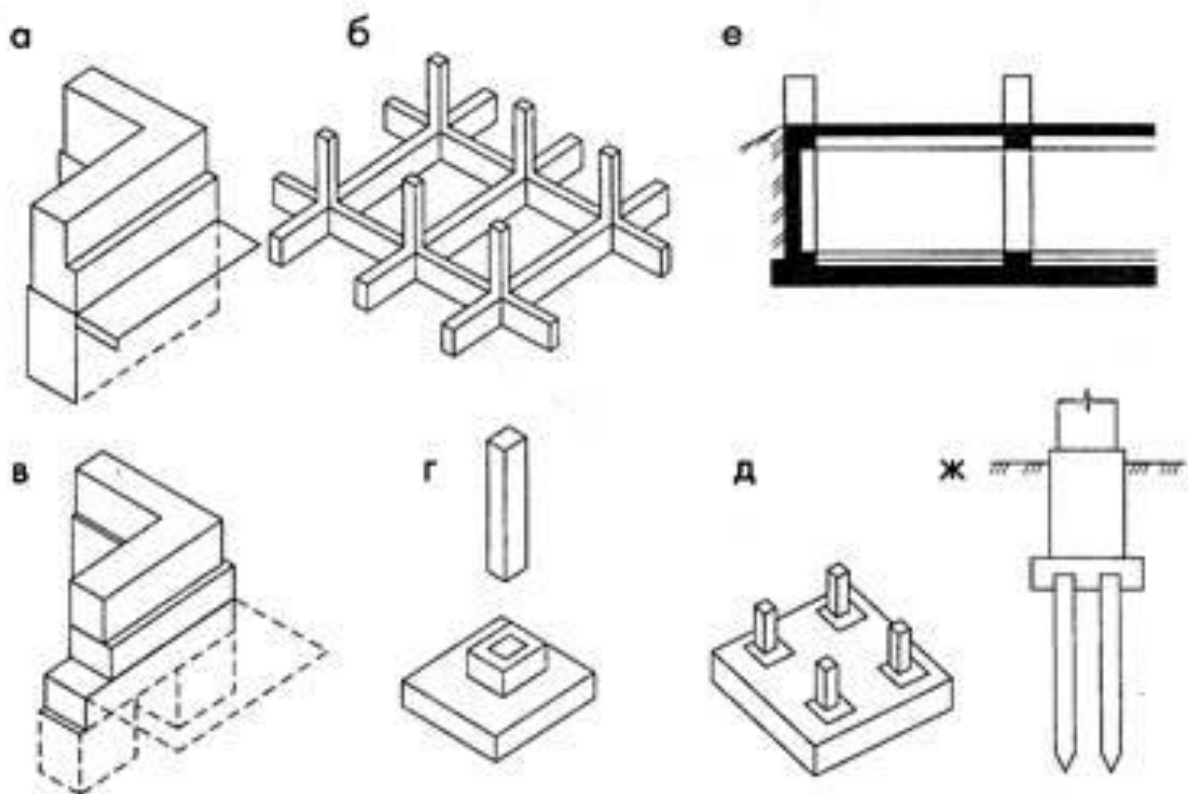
Типи фундаментів: а – стрічковий під стіни; б – стрічковий монолітний під колони; в – стовпчастий під стіни; г – стовпчастий стаканного типу під колону; д – суцільна плита під колони; е – коробчастий під будівлю; ж – пальовий
